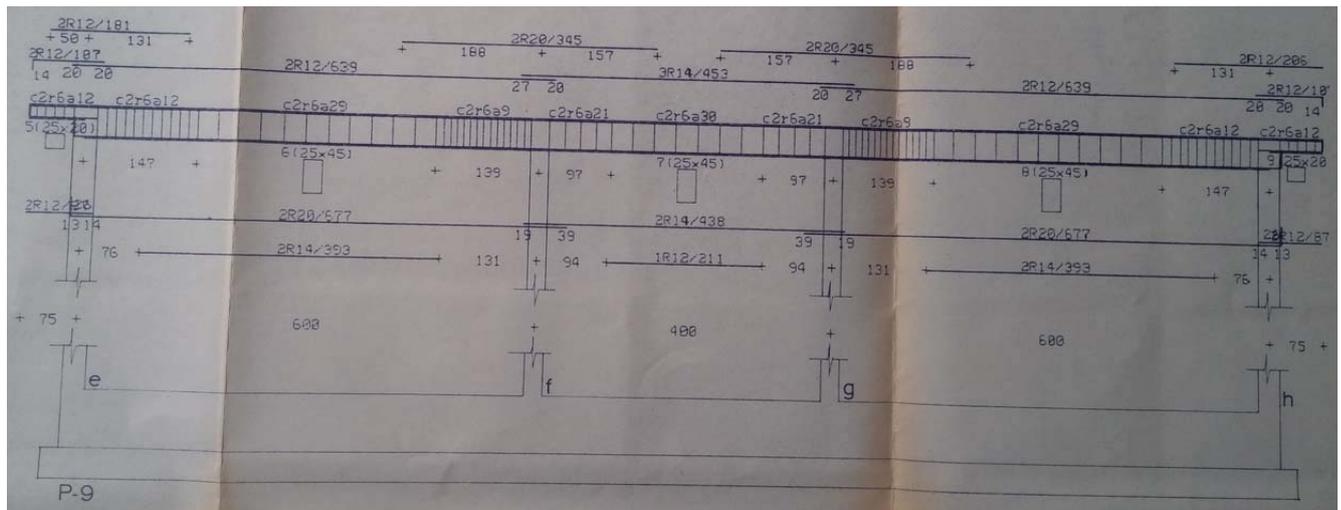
Pórtico P9. Geometría y armado de proyecto.
